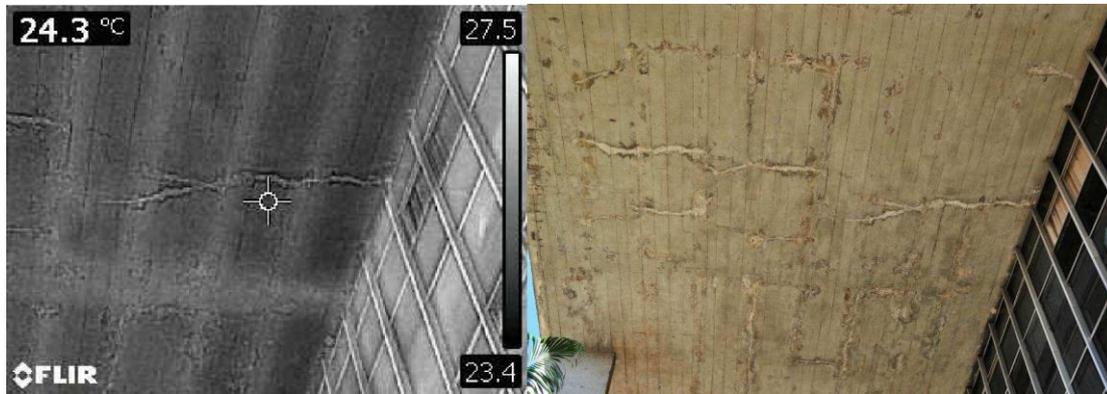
Fachada Leste - Laje de cobertura/vista inferior – manchas brancas e posição das vigas
